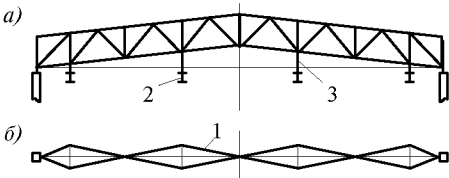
Предварительное напряжение ферм и подвесных подкрановых балок петлевыми затяжками, натягаемыми путем их отклонения из плоскости фермы
